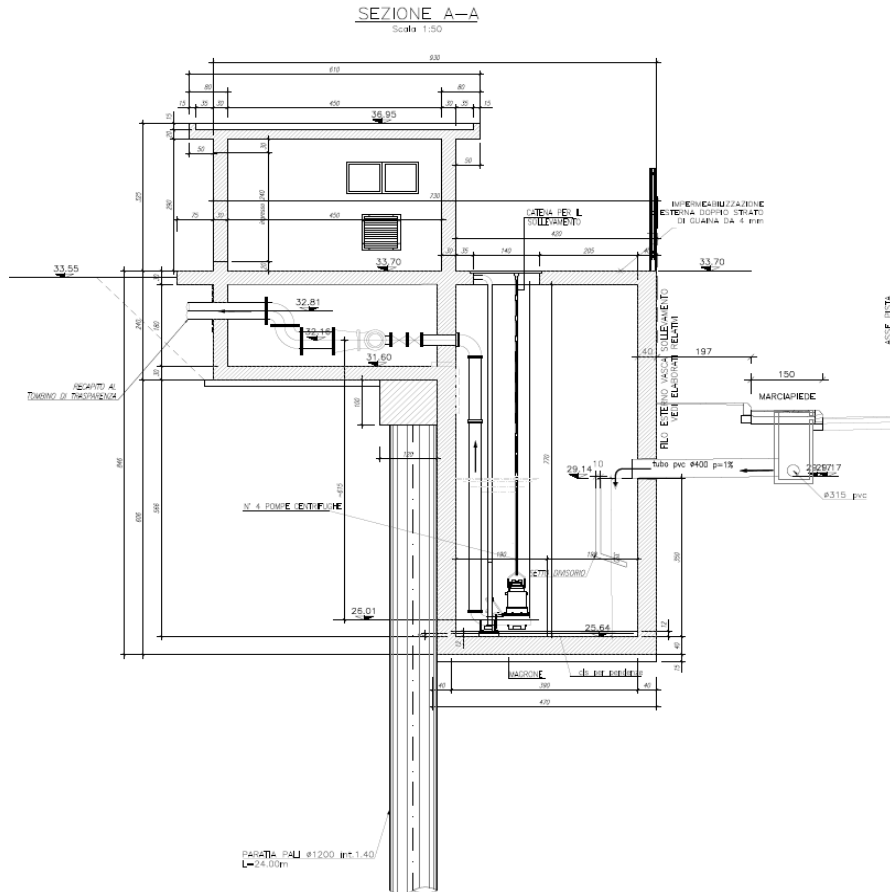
Impianto di sollevamento NV16 – Sezione
